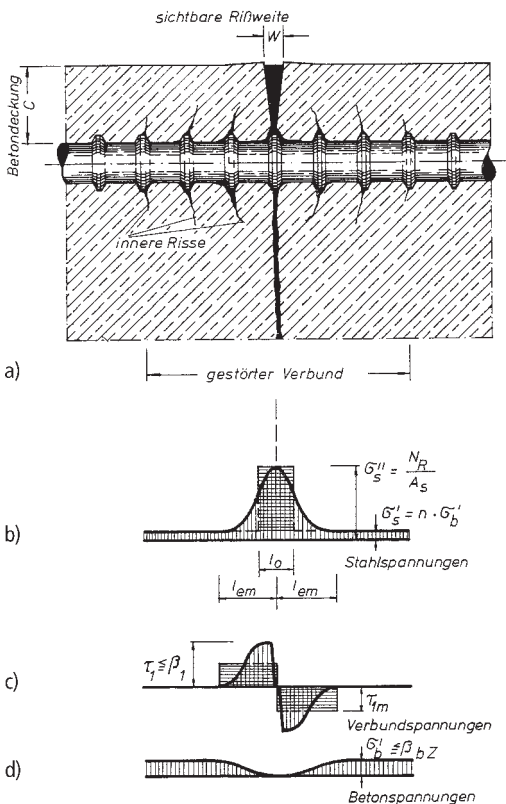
Rissbild und zugehörige Stahl-, Verbund- und Betonspannungszustände in einem beanspruchten Betonbauteil mit Rippen-Stahlbewehrung (aus [6])
